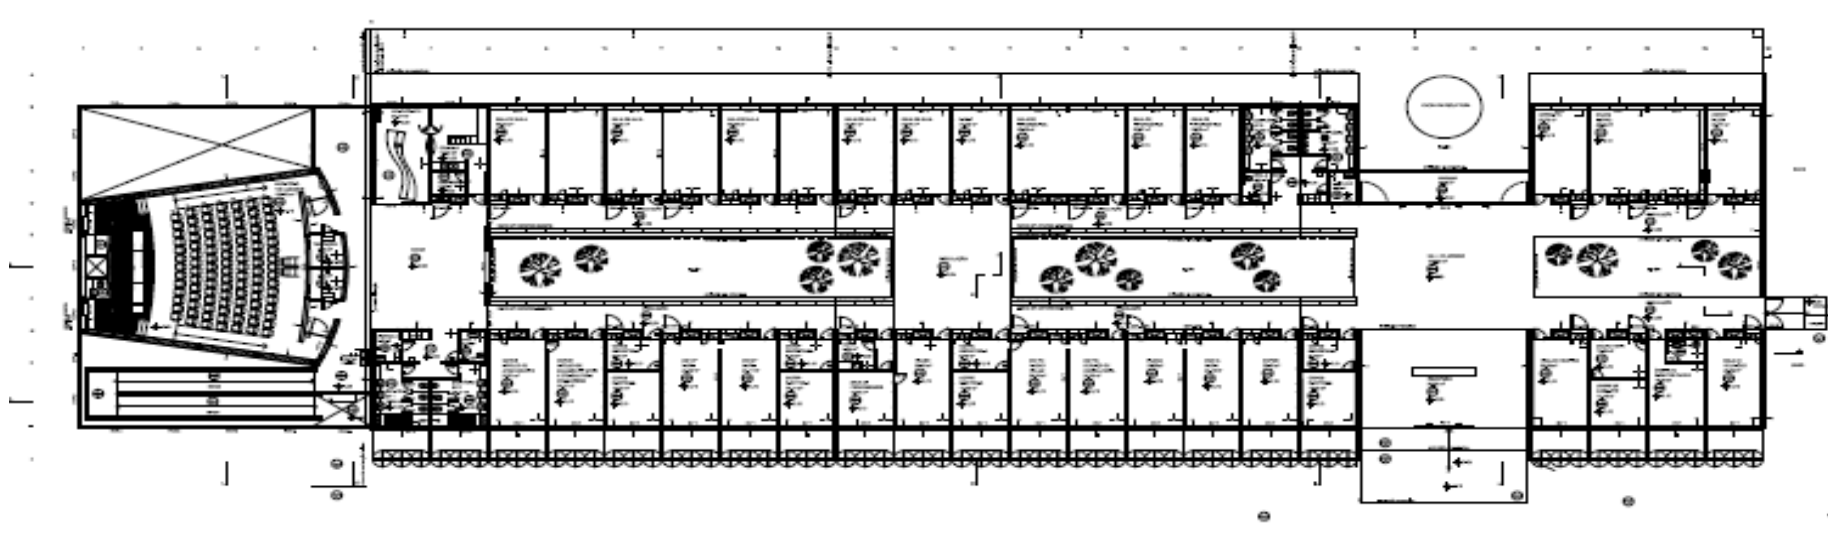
Pavimento térreo em estrutura mista (vigas baldrames em concreto armado; pilares das juntas 2,3 e 4 metálicos; auditório em concreto armado, inclusive pilares).
